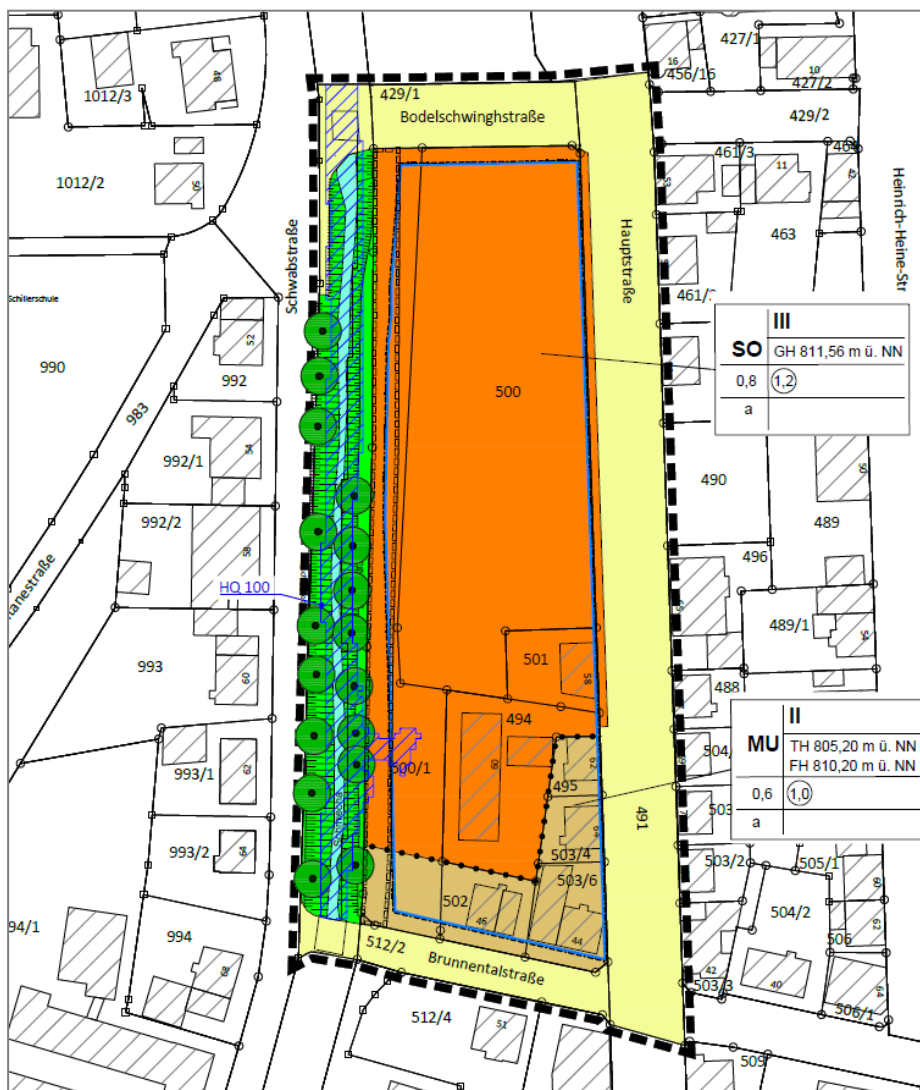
Bebauungsplan „Bodelschwinghstr. / Brunnentalstr.“, Stadt Albstadt (Stand: 05.04.2019)
